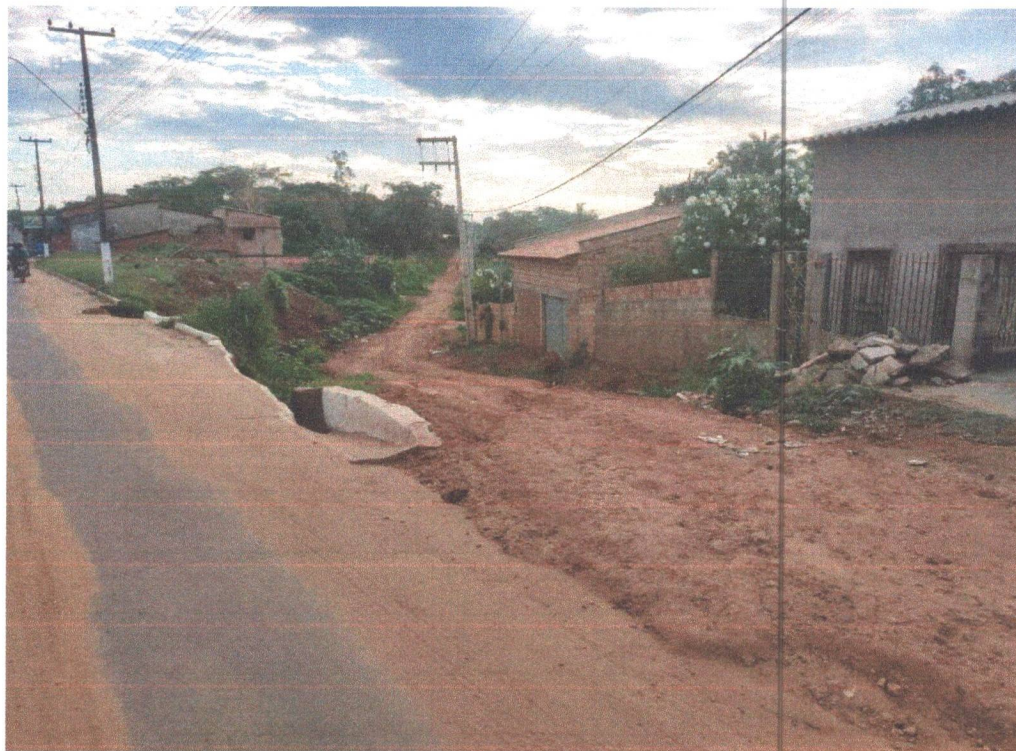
INICIO DA PAVIMENTAÇÃO
